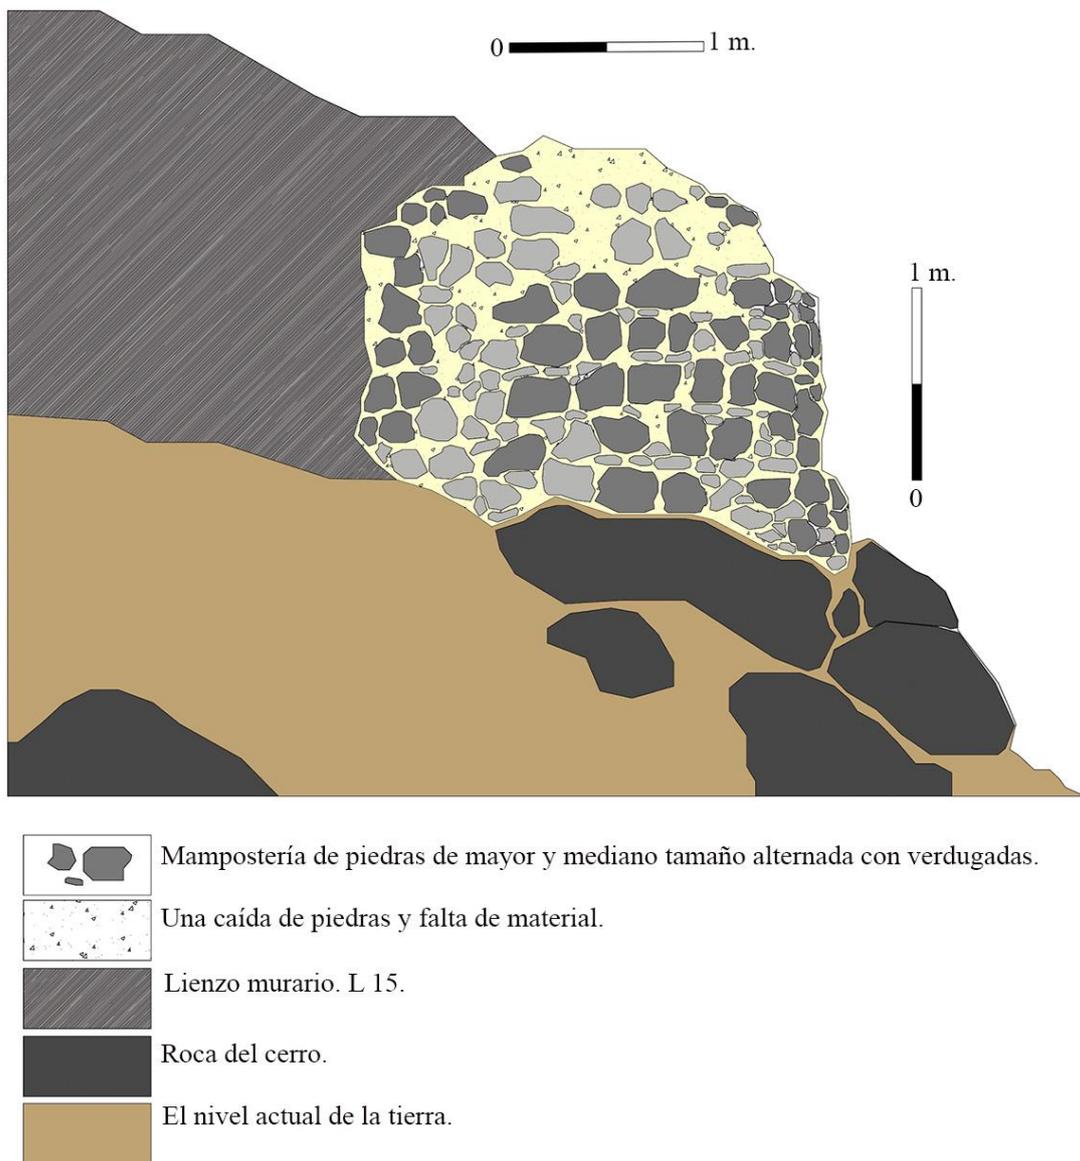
Torre (T_16) en su cara este. La técnica constructiva, mampostería enripiada con verdugadas de ripios. (Elaboración propia).
